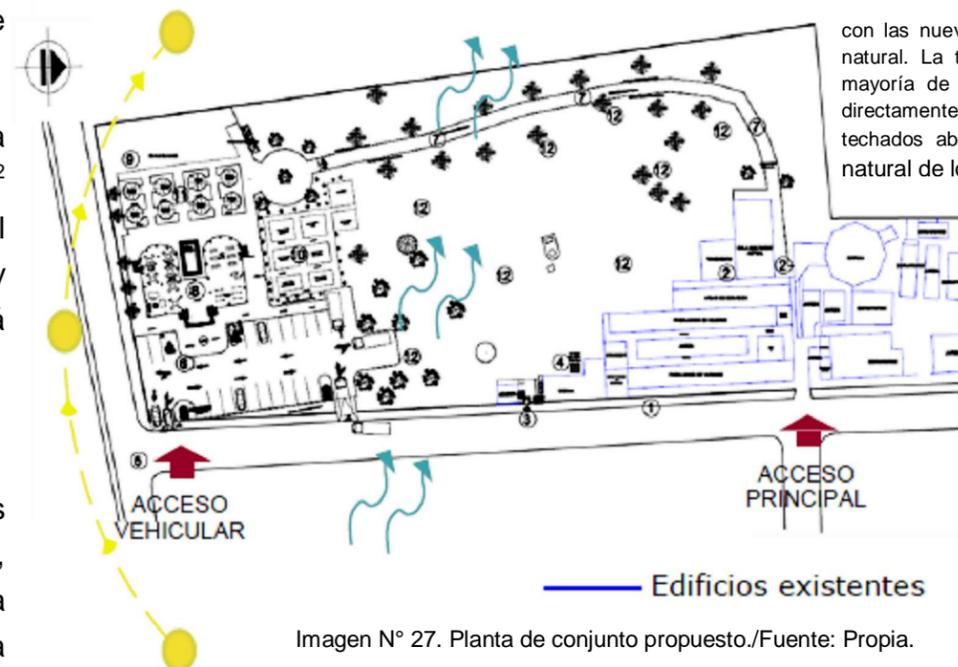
Planta de conjunto propuesto./Fuente: Propia.
